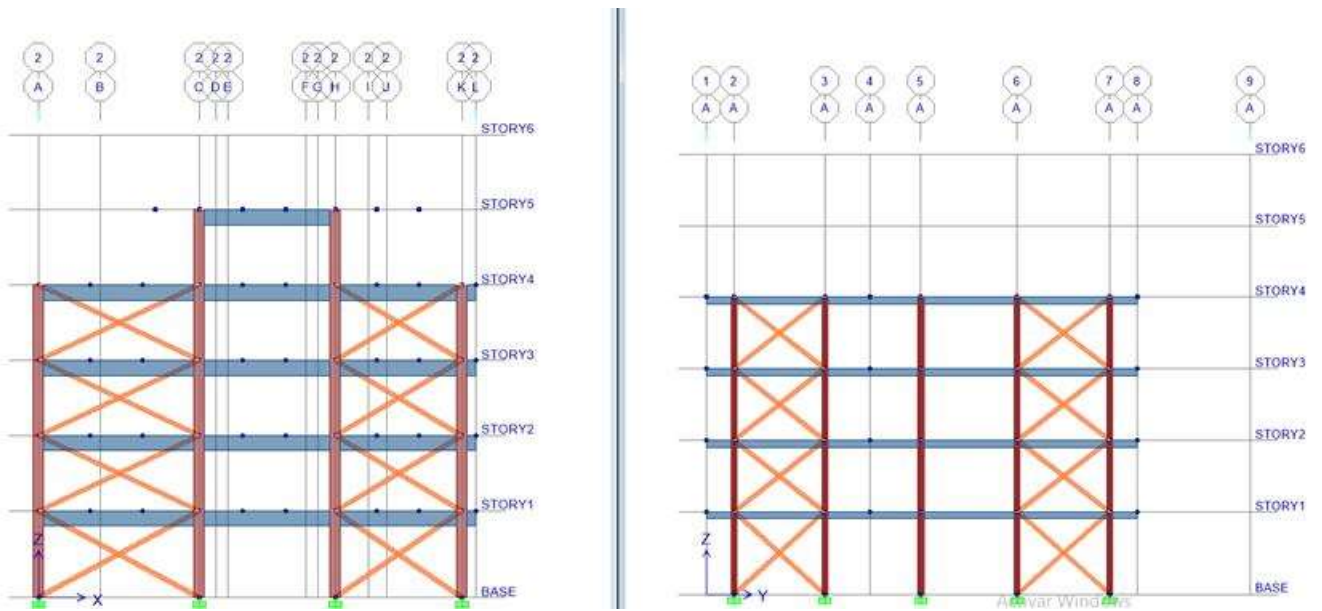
Esqueleto Estructural para el proyecto ETABS – Vistas Laterales
